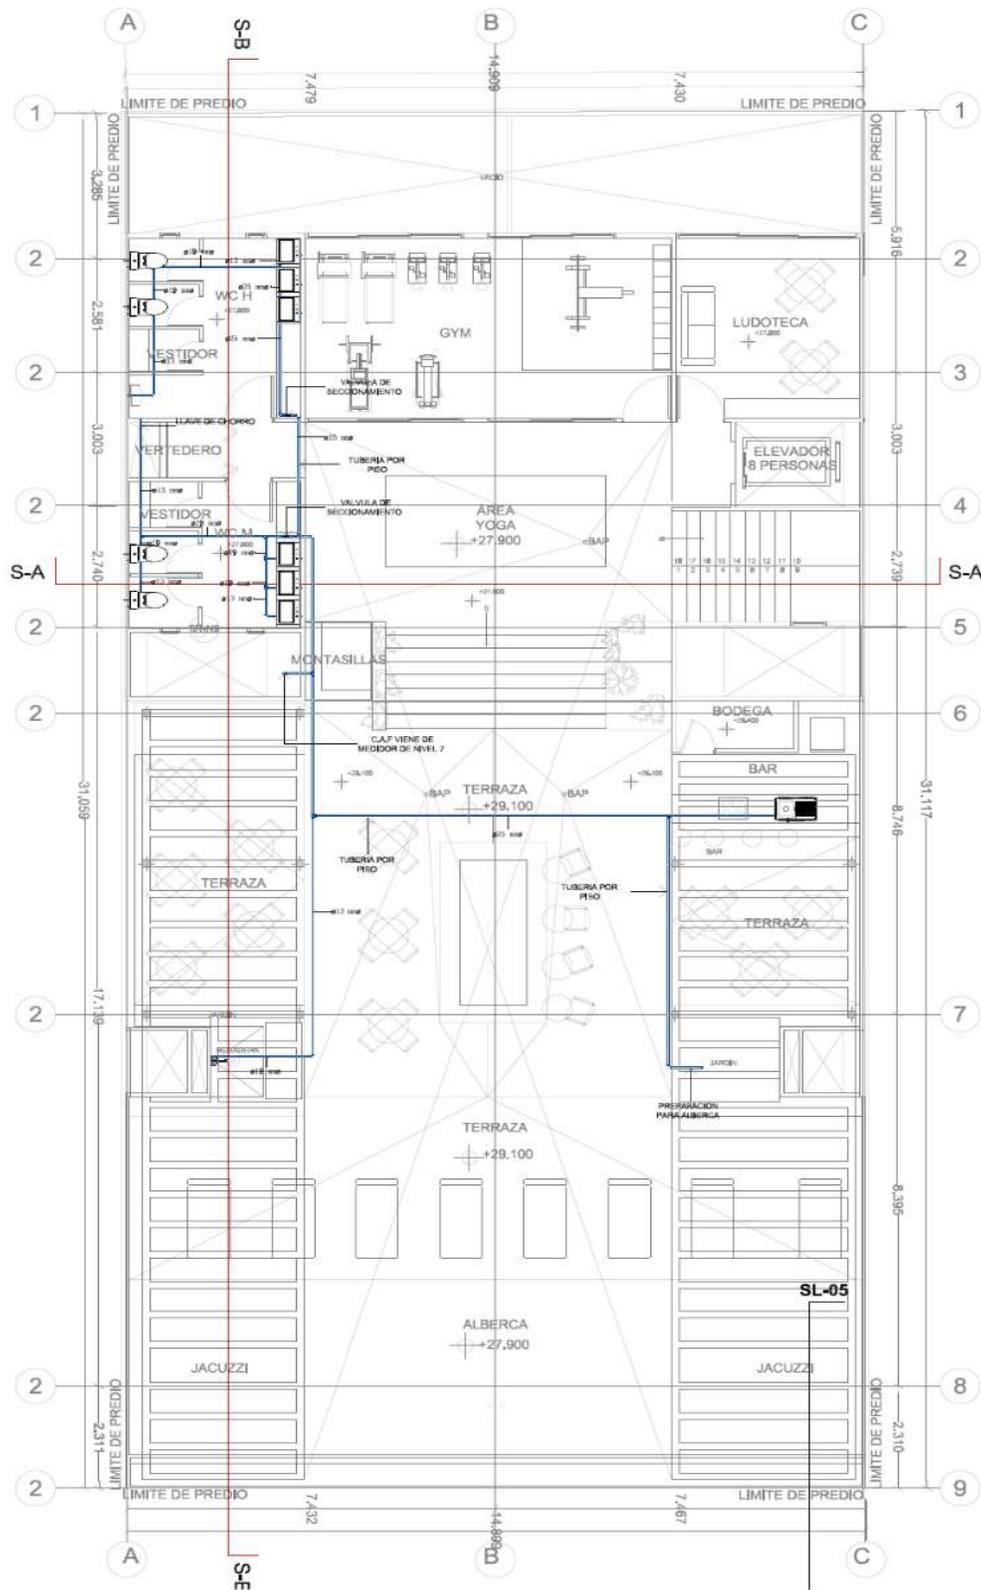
Ingeniería hidráulica niveles 01-07
